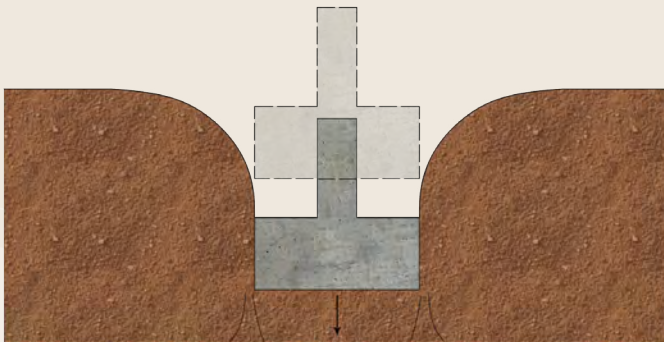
Falla por punzonamiento bajo un elemento de cimentación.
